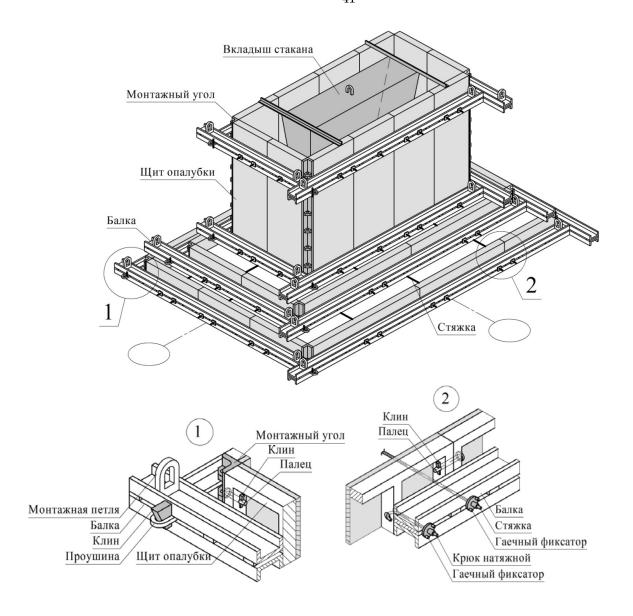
Схема мелкощитовой опалубки монолитного фундамента
